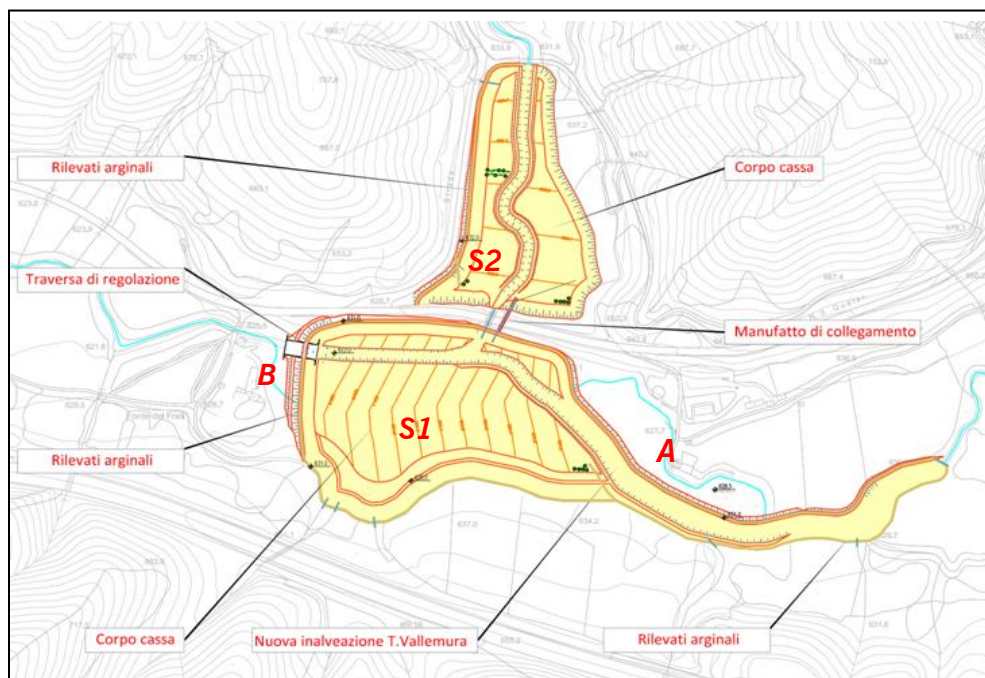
Perimetrazione della cassa sul T.Vallemura, suddivisa in due partizioni.
